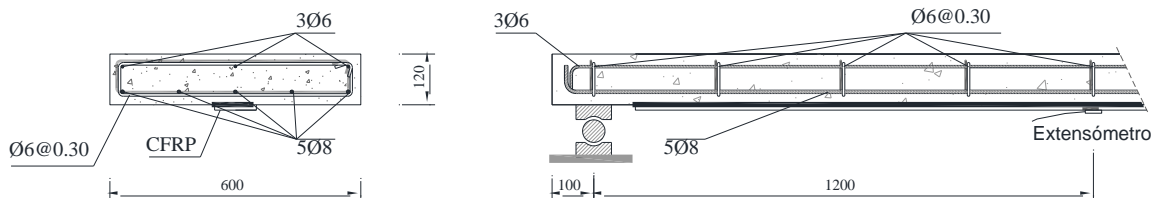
Geometria e configuração de ensaio: a) secção transversal; b) secção longitudinal.
